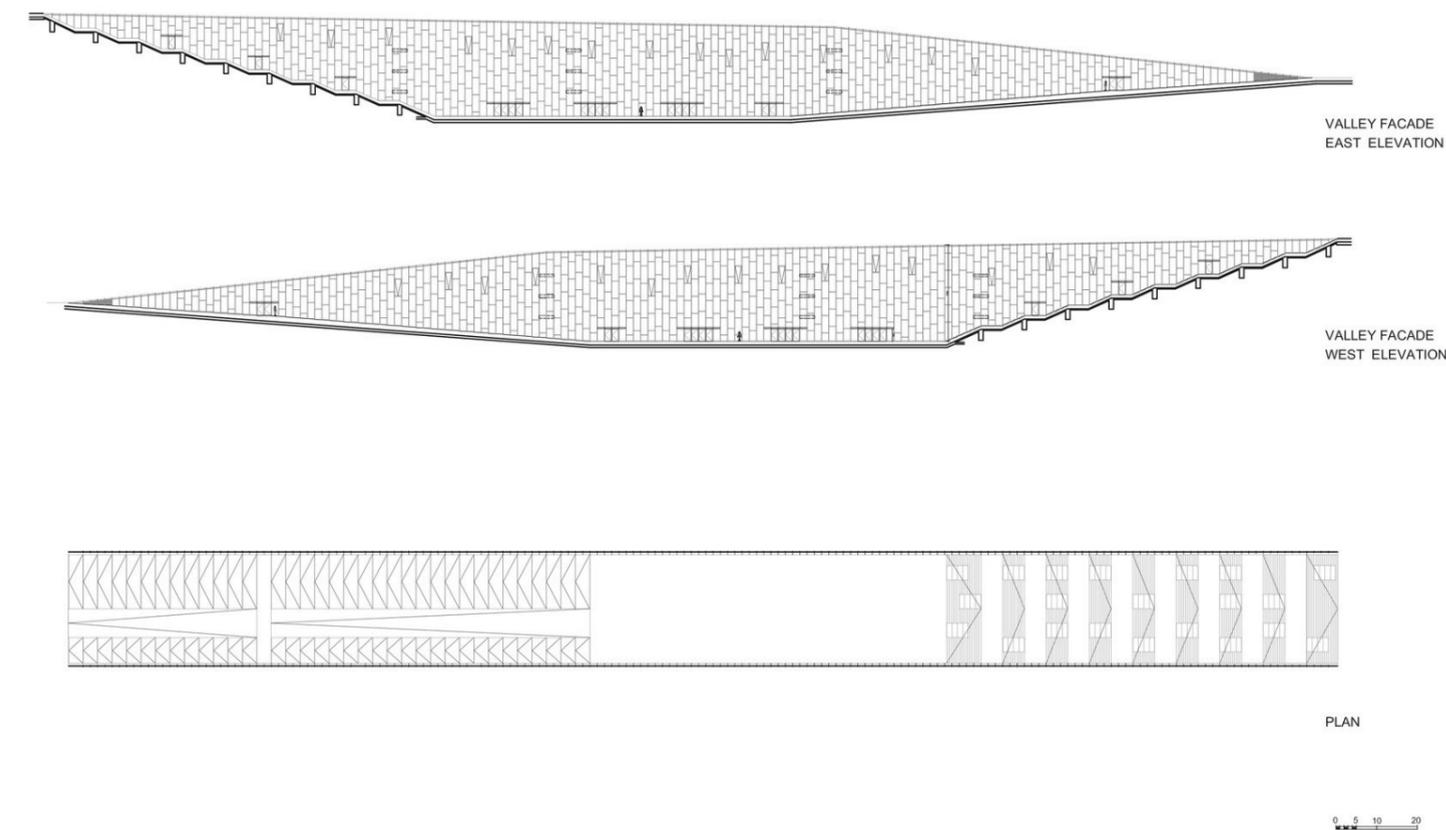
Planta e elevações do campus central da Universidade Ewha. Fonte Archdaily, 2012.
